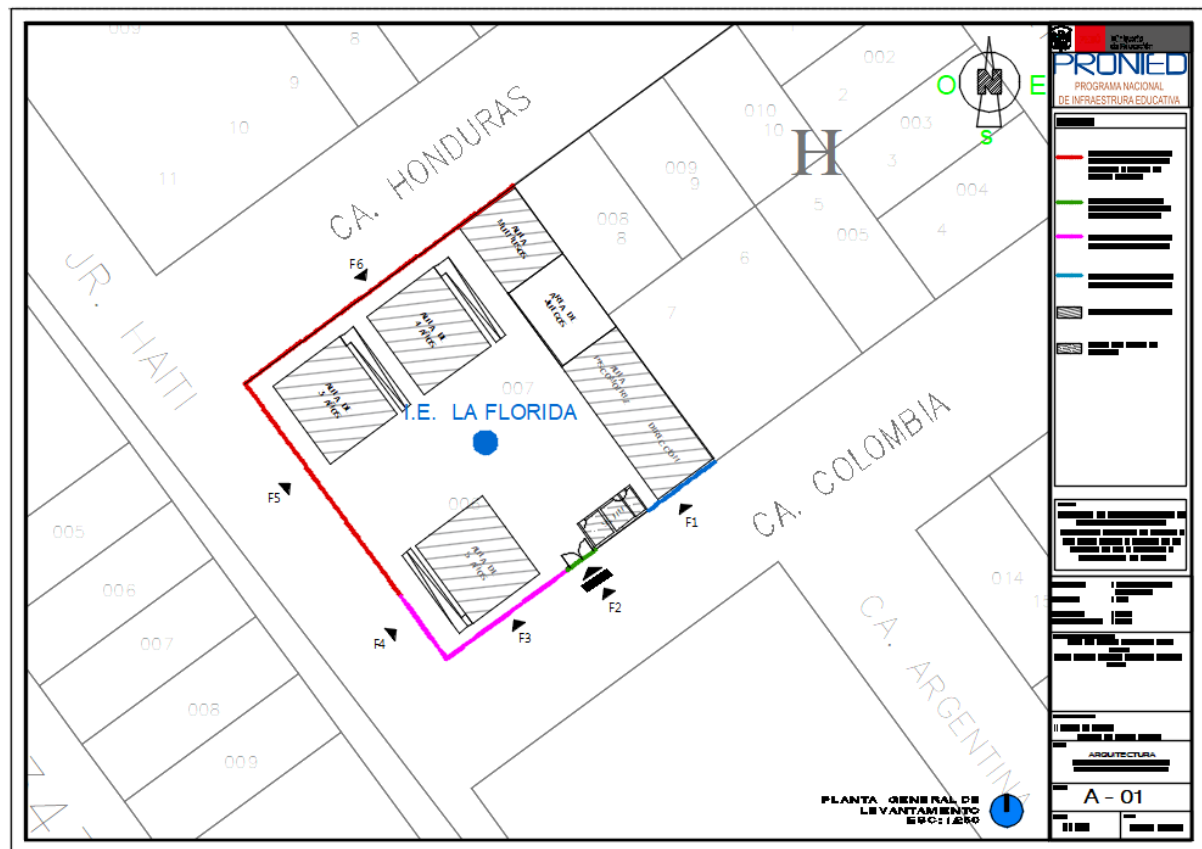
I.E. La Florida: Planta de levantamiento de infraestructura: Acondicionamiento de Cerco perimétrico de 88.60 ml = 29.30 ml. Calle Honduras (F6) lindero posterior y 23.18 ml. Jr. Haití (F5) lindero izquierdo con presencia de cerco de calamina metálica, 6.82 ml Jirón Haití (F4) lindero izquierdo y 13.22 ml Calle Colombia (F3) lindero frontal con paneles de madera , 3.08 ml Calle Colombia (F2) lindero frontal con portón de ingreso y 7.31 ml Calle Colombia (F1) lindero frontal con paneles de triplay y 5.69 ml de muros de albañilería.
